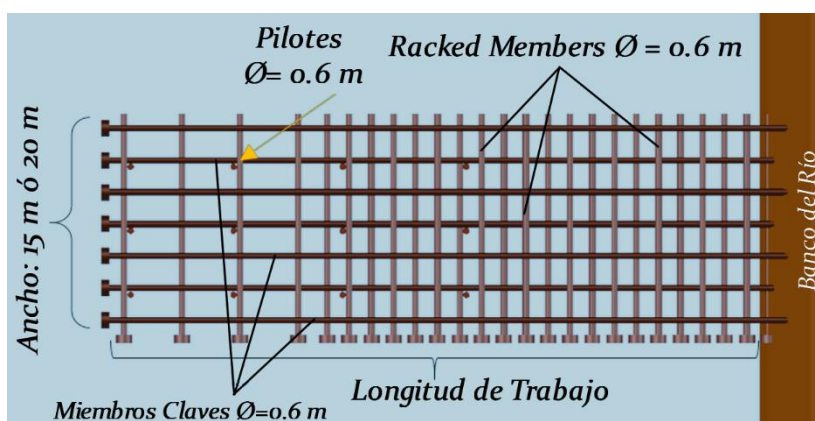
Vista en planta de un Espigón Fabricado con Troncos de Árboles.
